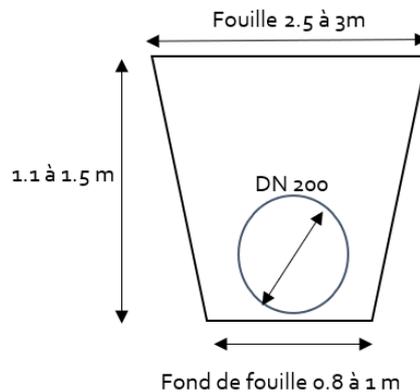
schéma de coupe pour l'enfouissement de la conduite
